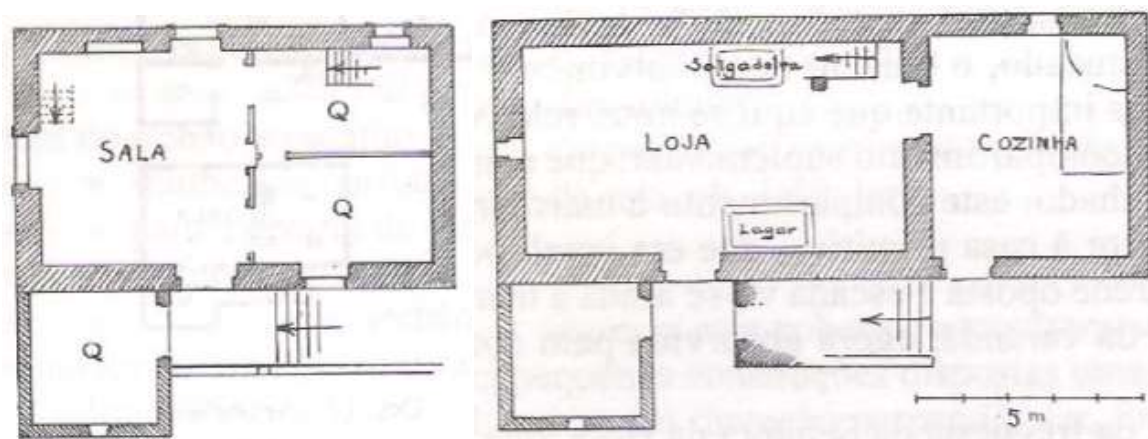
Planta de uma casa rural da Barranha, Porto: datada de 1694 (Oliveira, 2003).
